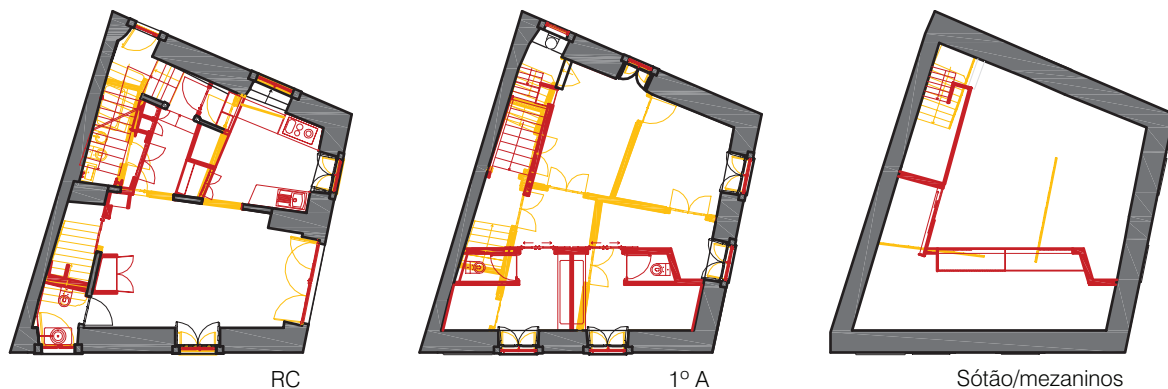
Plantas de alterações - demolições a amarelo, construções a vermelho (sem escala)
